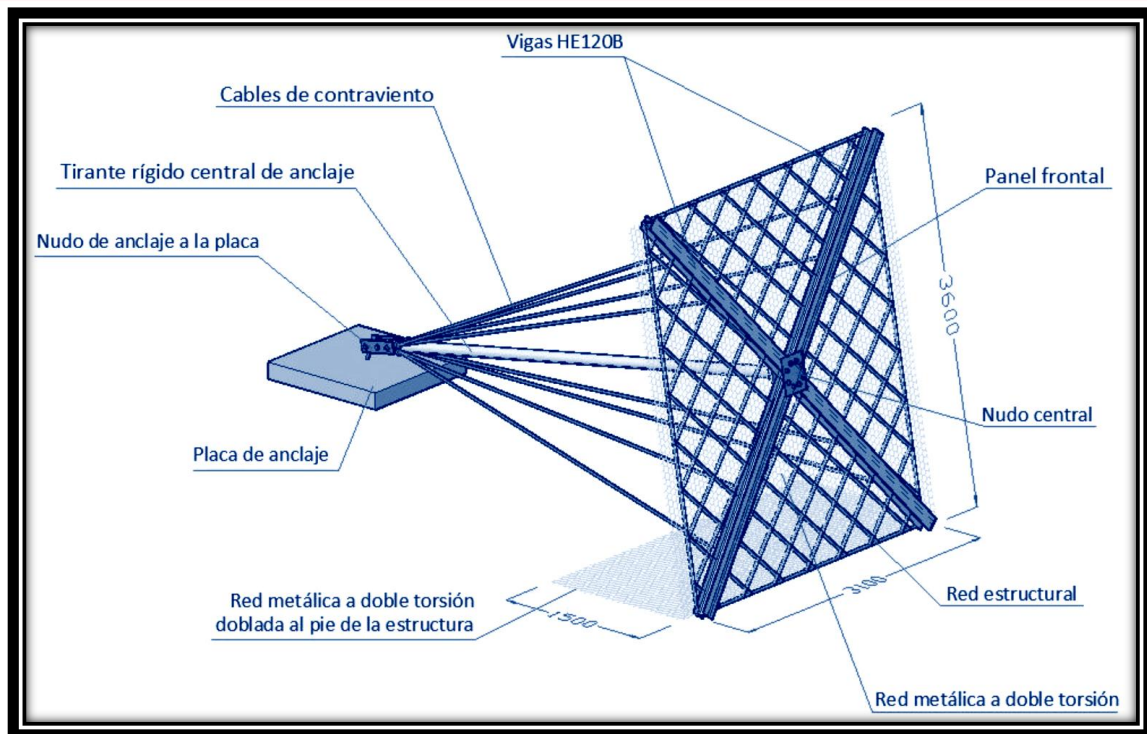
Elementos del Sistema (Fuente: Betonform LA)
